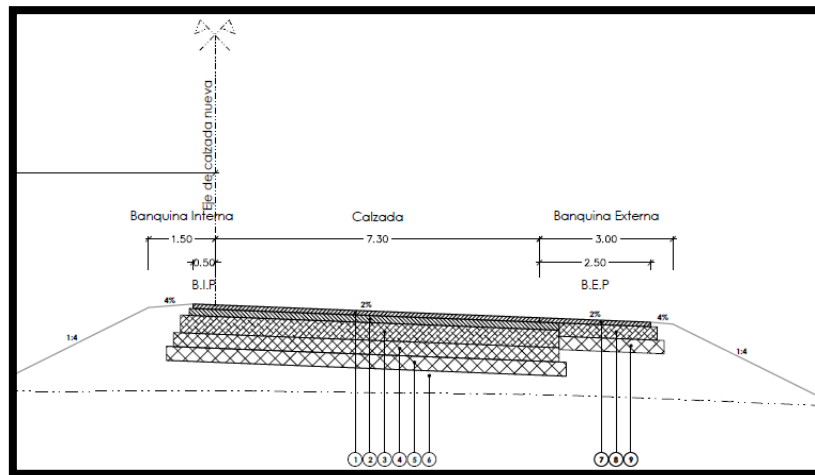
Perfil tipo de pavimento para la Sección 2, PR 0+000 a 30+800.
